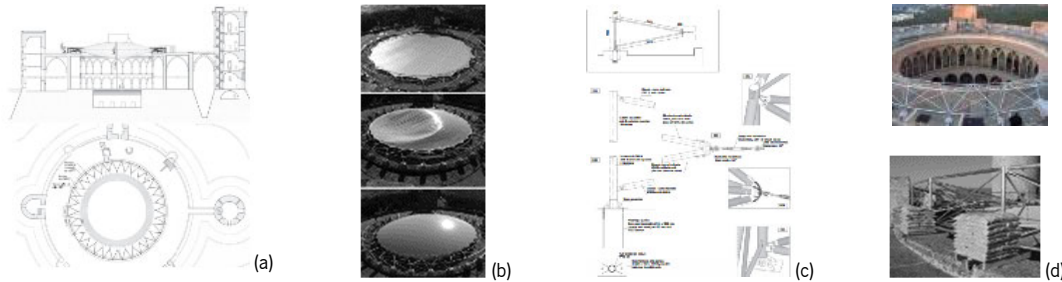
Castelo de Bellever (Maiorca, Espanha): (a) desenhos gerais da estrutura amovível (desenhos elaborados por Ramon Sastre); (b) etapas de instalação da cobertura insuflável (foto de Ramon Sastre apud Zanelli, 2015); (c) Pormenores de ligação da cobertura aos elementos resistentes existentes; (d) balastros de ancoragem da estrutura em membrana (totalmente reversíveis) (Tensinet, 2010).
